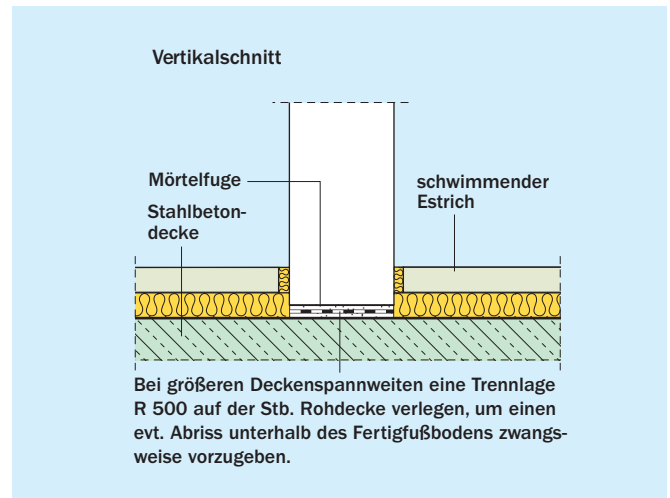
Trennlage am Wandfuß zwischen Mauerwerkswand und Stahlbetondecke
